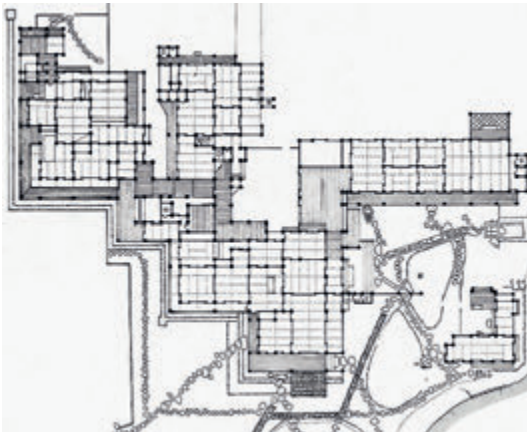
Plano Villa Katsura. Sistema extensivo.
